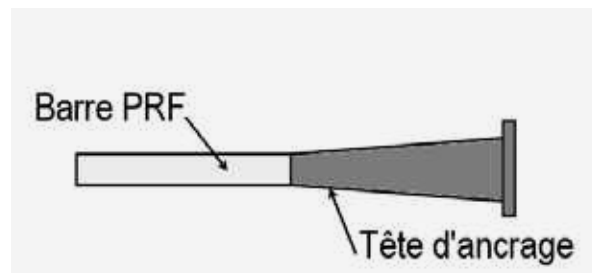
schéma d'une barre PRF avec une tête d'ancrage
